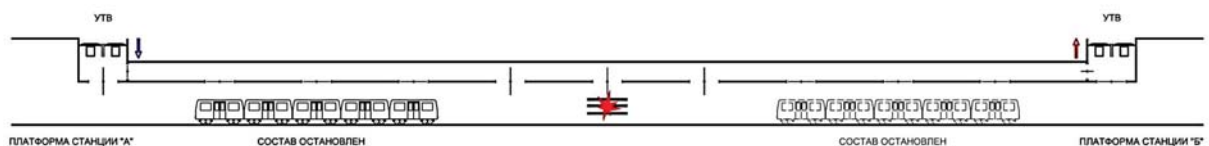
Продольно-поперечная схема противодымной вентиляции при пожаре на стационарном объекте в тоннеле
